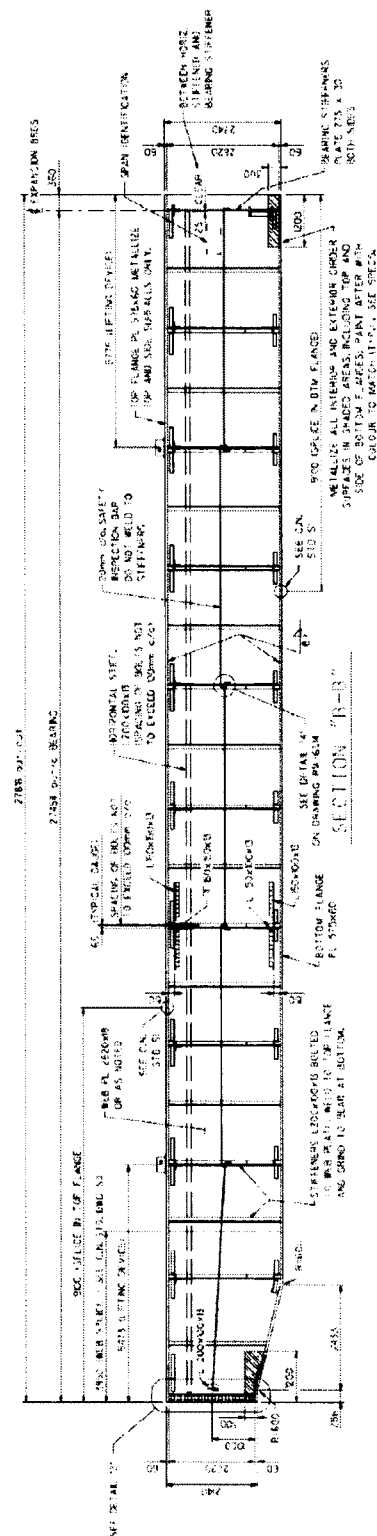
Section transversale d'un pont bi-poutres de 26,48m [CN Dessin R1A-61.09]
